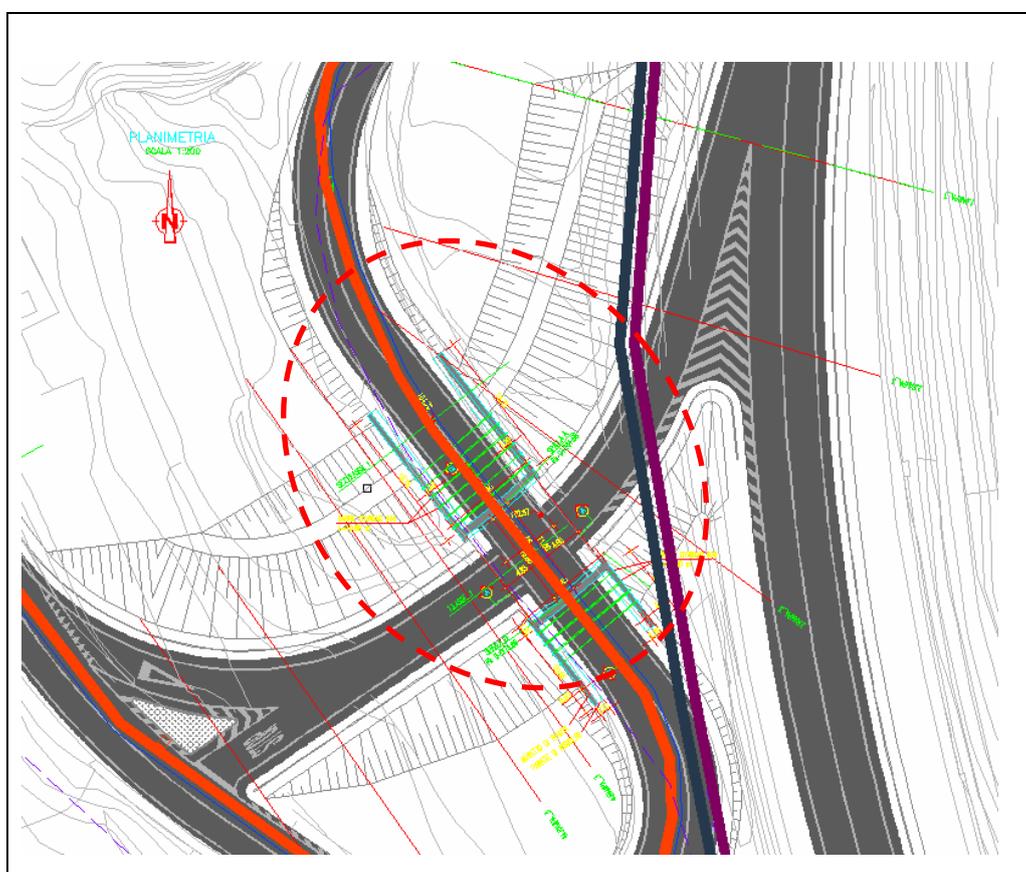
Stralcio planimetrico dell'opera con indicazione sottoservizi
